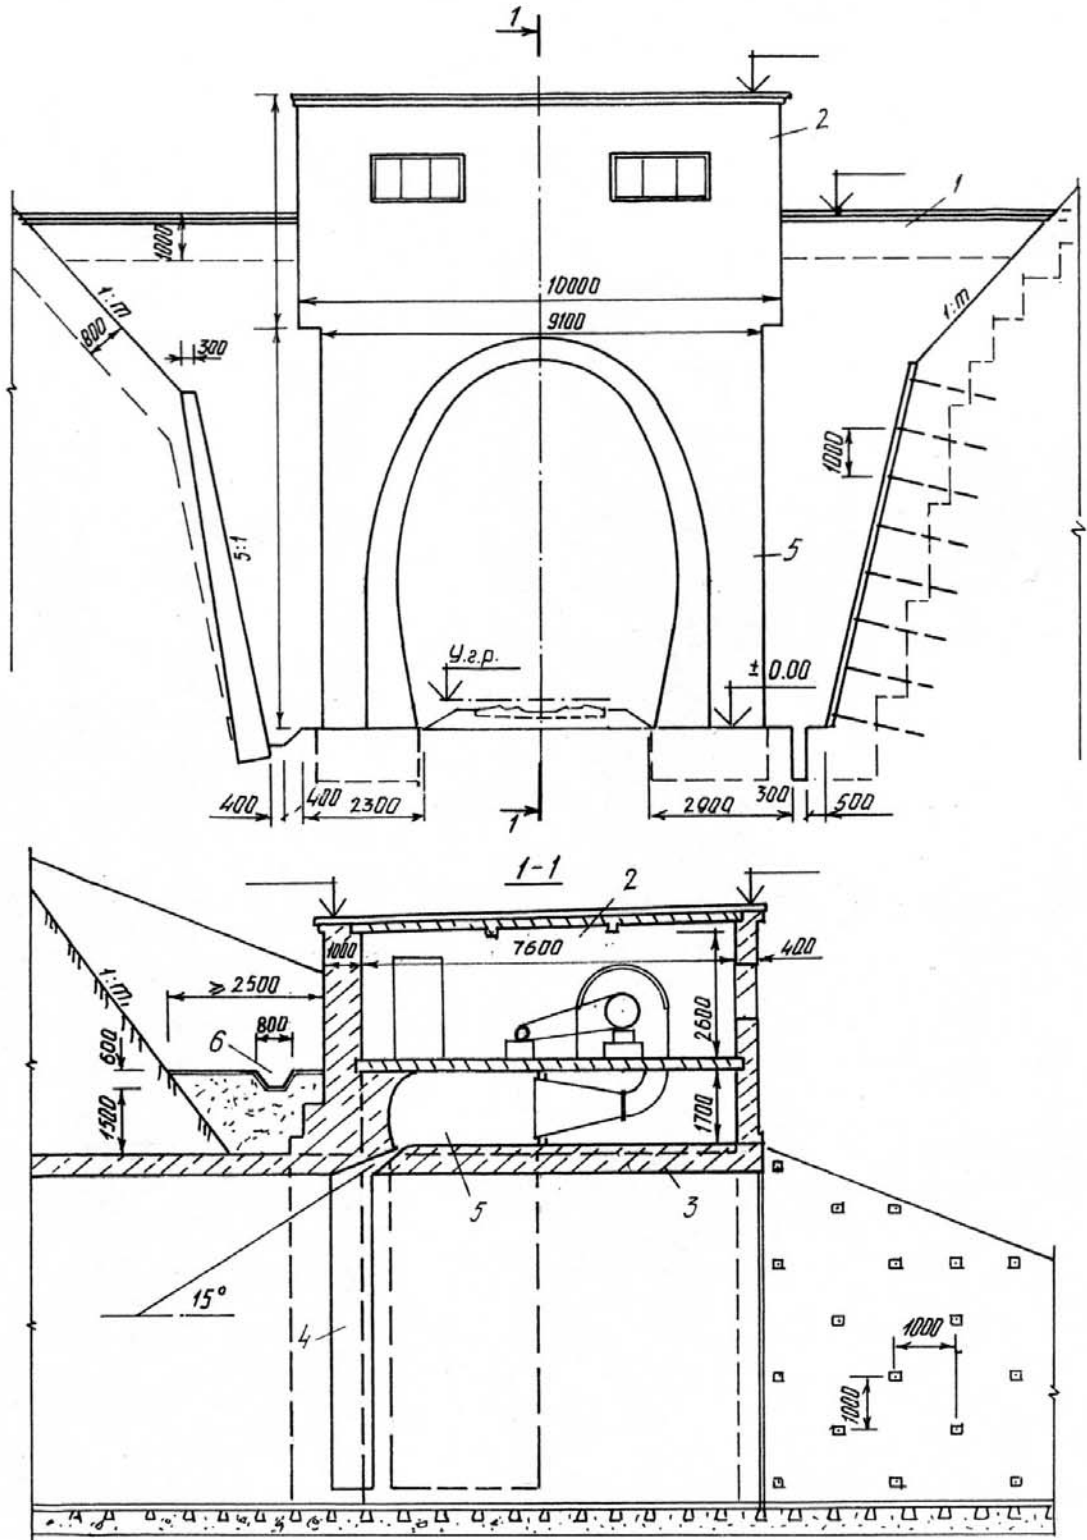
Портал железнодорожного тоннеля с вентиляционным зданием
